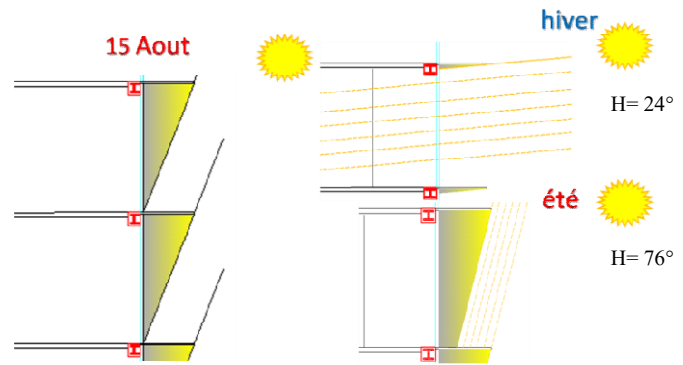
Brises soleil sur façade sud du projet. Source : Auteurs.
